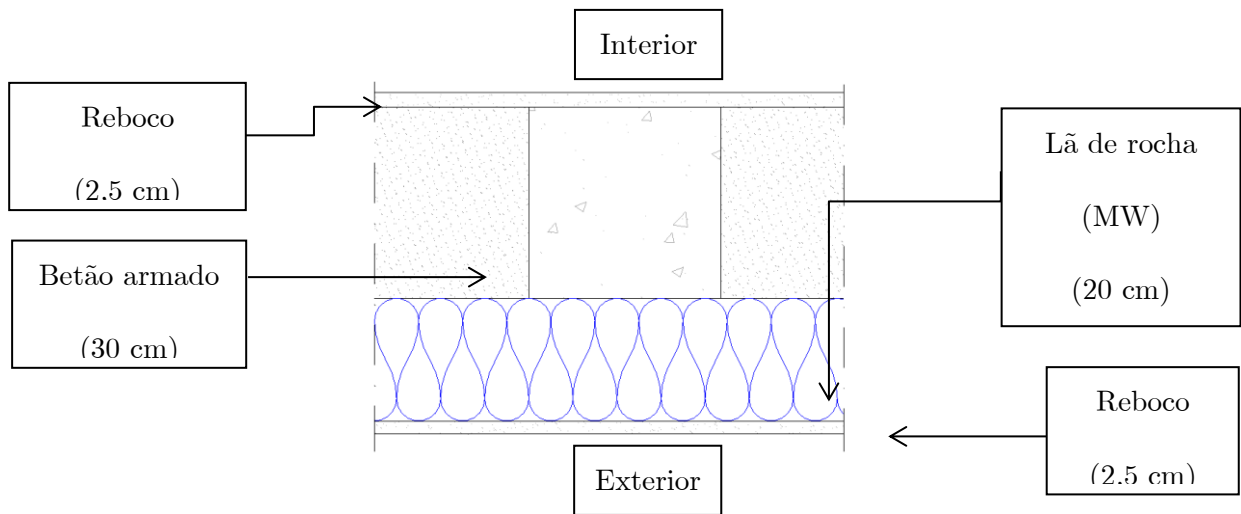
Pormenor construtivo dos pilares (N<sub>4</sub>)
